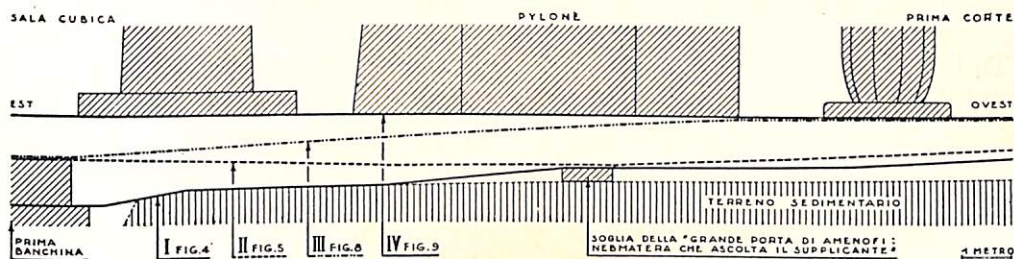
PAVIMENTI AD OVEST DELLA PRIMA BANCHINA (SEZIONE LONGITUDINALE)
